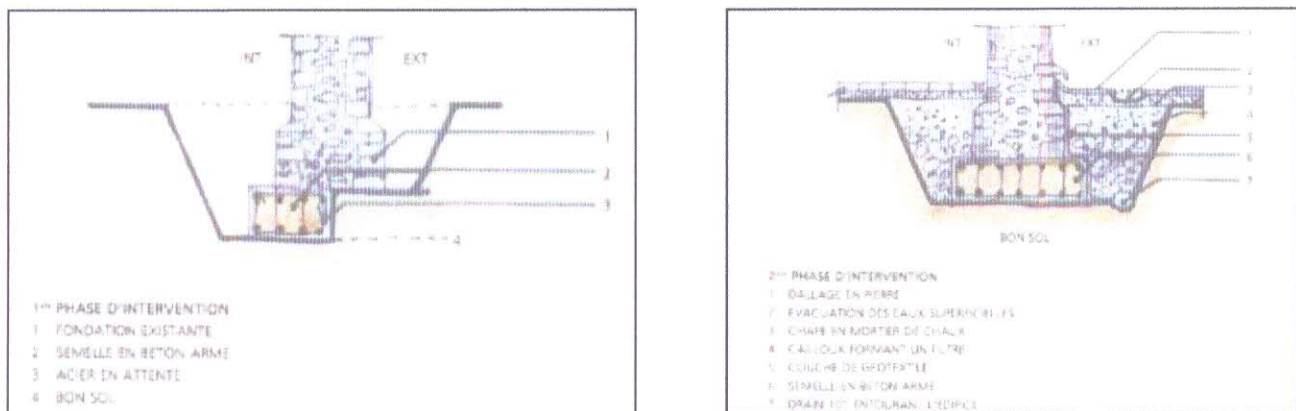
Reprise en sous œuvre d'une semelle en béton armé.
